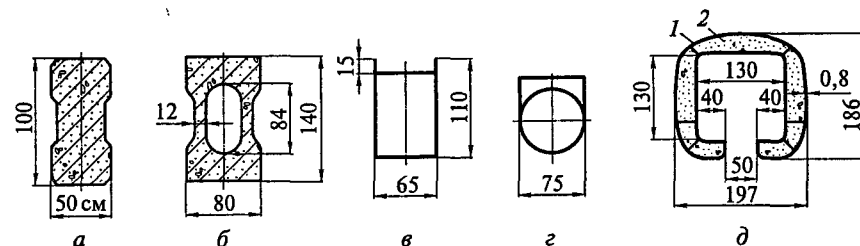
Поперечные сечения монорельсов из железобетона (а, б), стали (в, г) и сталежелезобетона (д):
